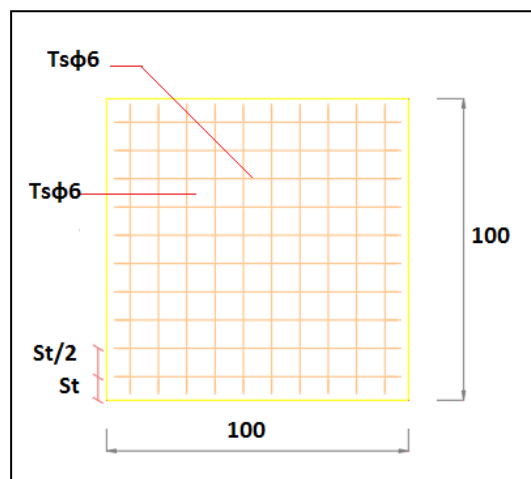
Disposition constructive des armatures de la dalle de compression.
